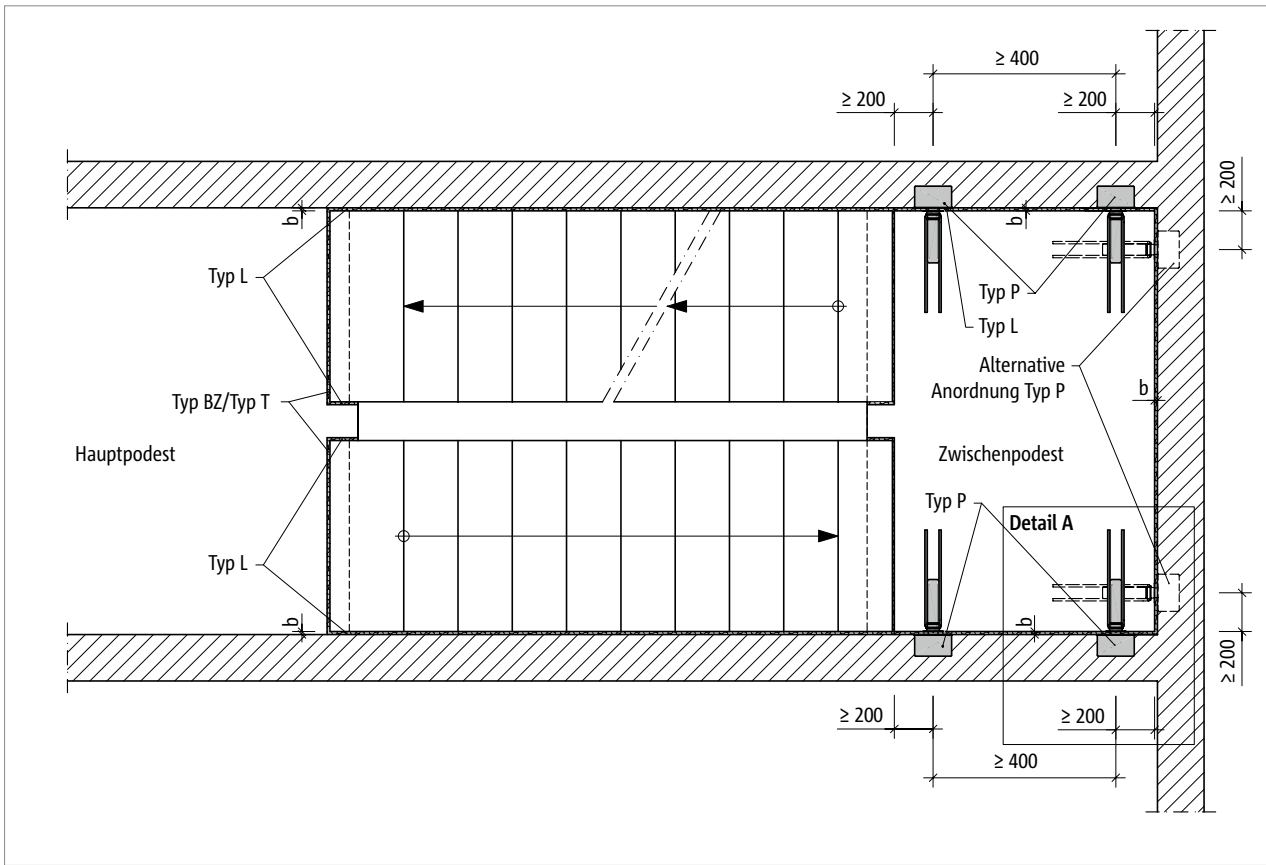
Schöck Tronsole® Typ P: Elementanordnung, Detail A, Fugenbreite  $b = 15 \text{ mm}$  bei Ortbeton, bei Elementtreppenläufen ist die Notwendigkeit einer zusätzlichen Einbautoleranz durch den Planer zu prüfen
